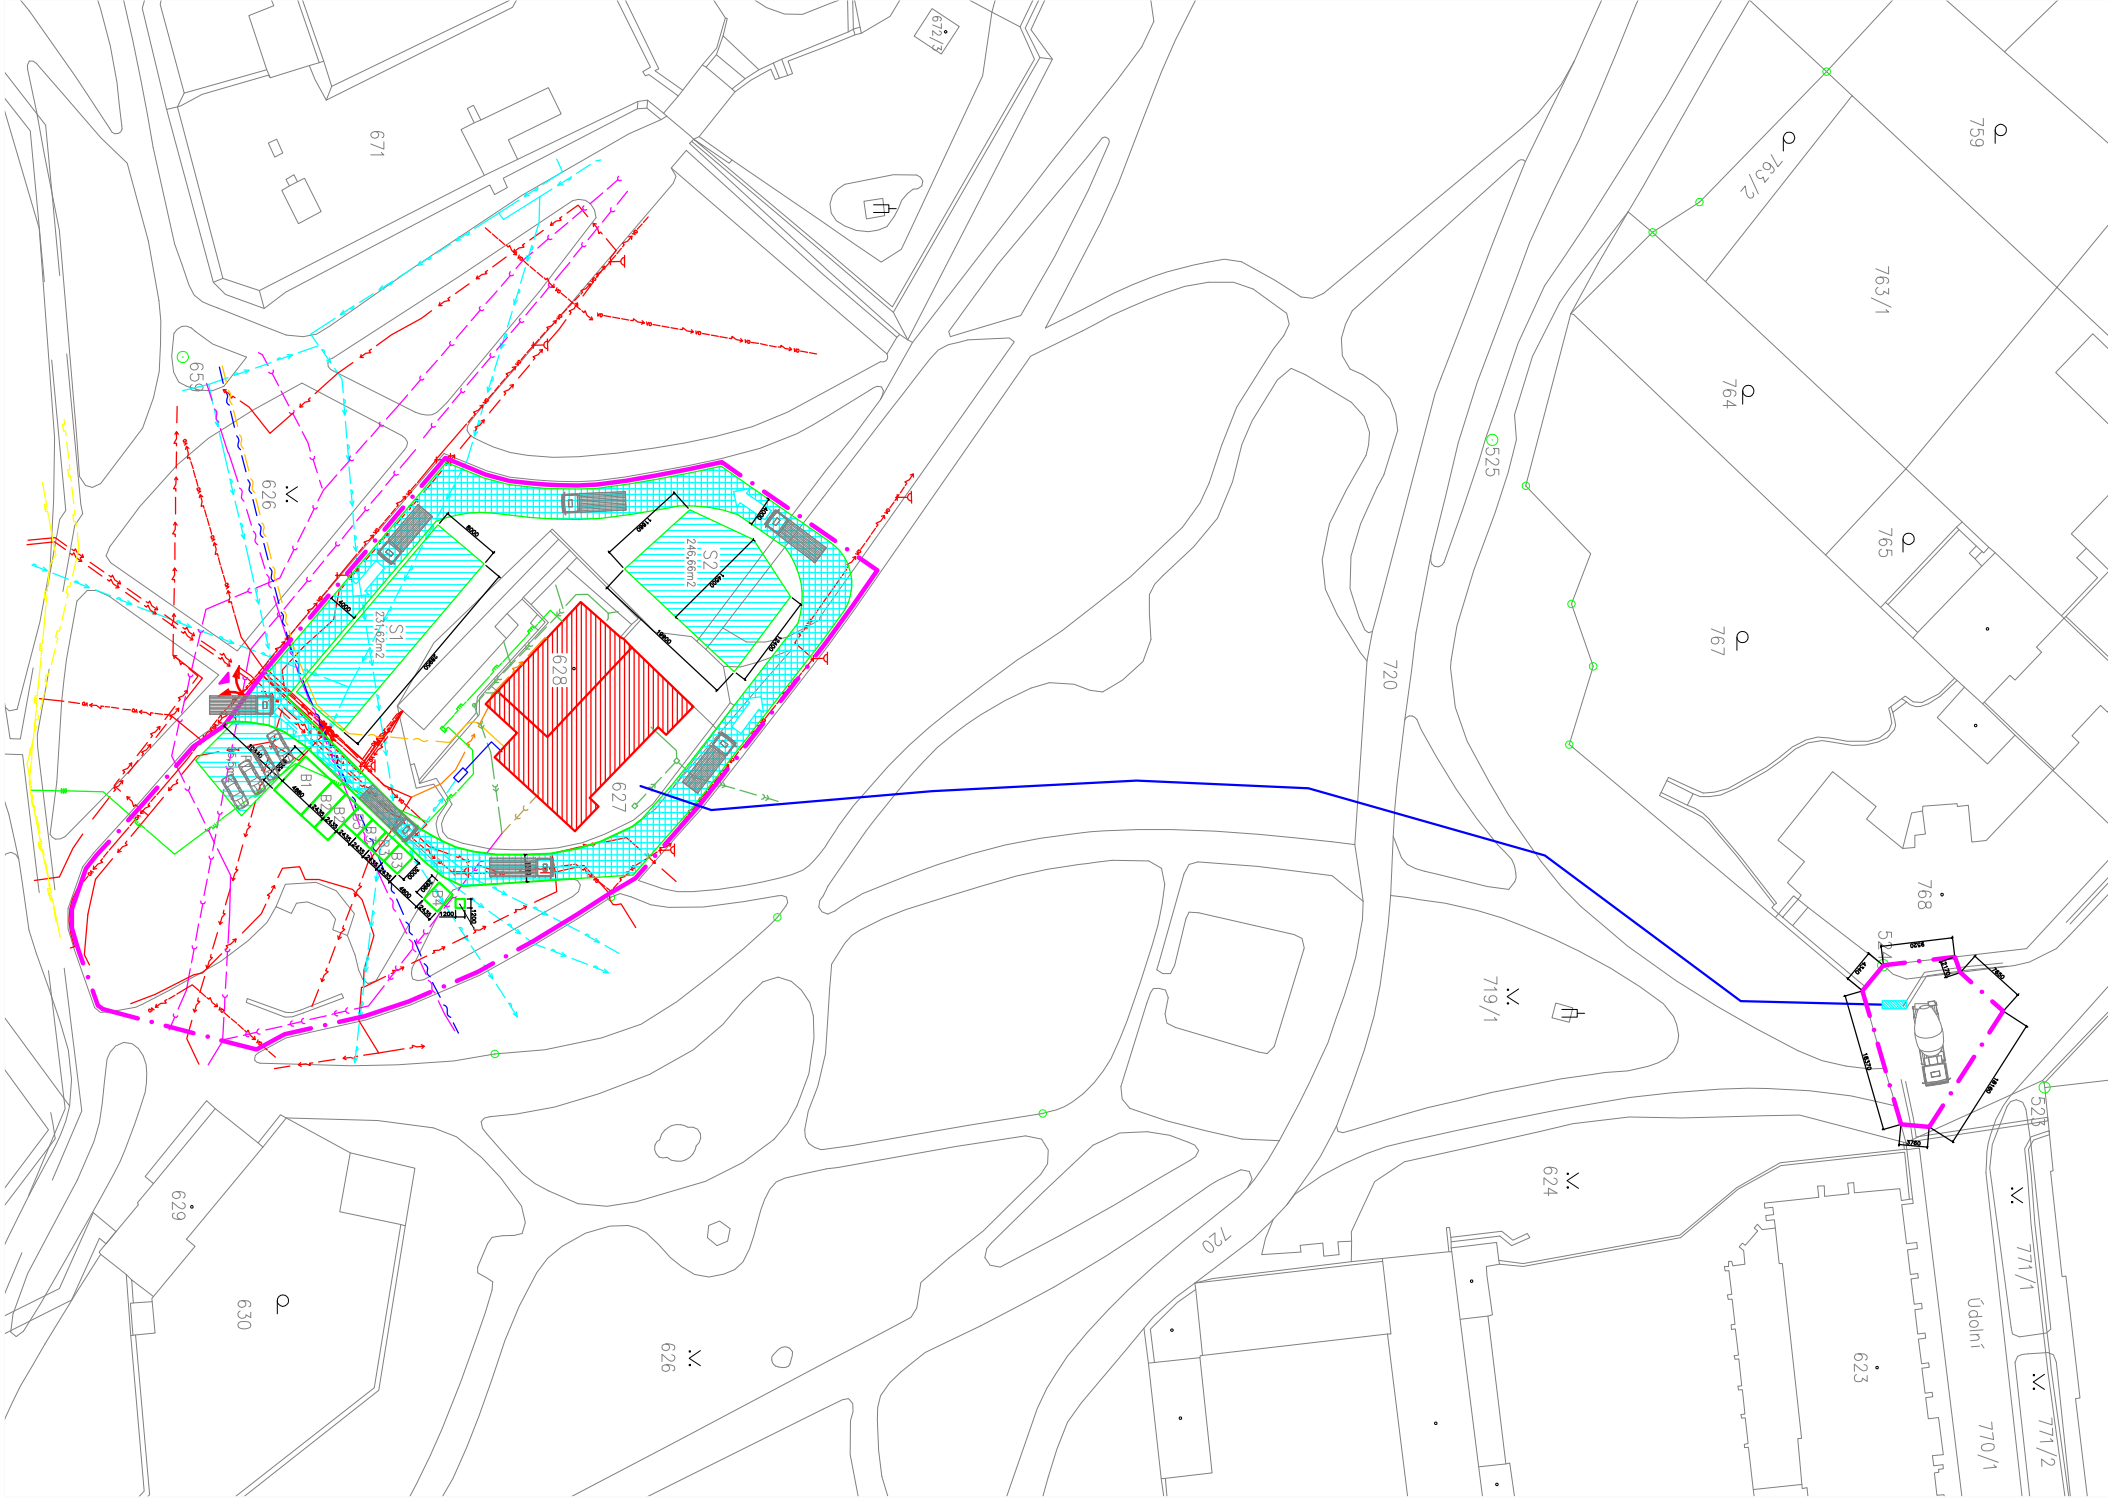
DETAIL UMÍSTĚNÍ BETONOVÉHO ČERPADLA 1:250
